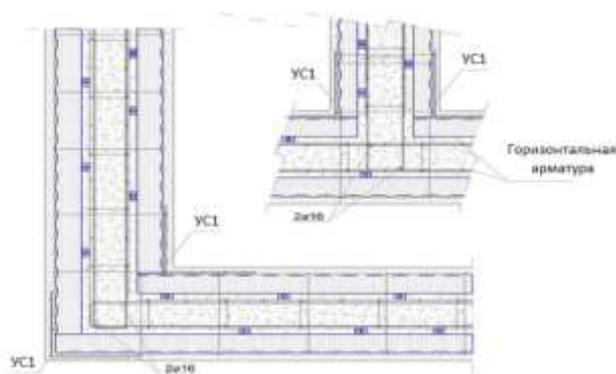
Закладка арматуры в местах пересечений и в углах между двойными панелями
